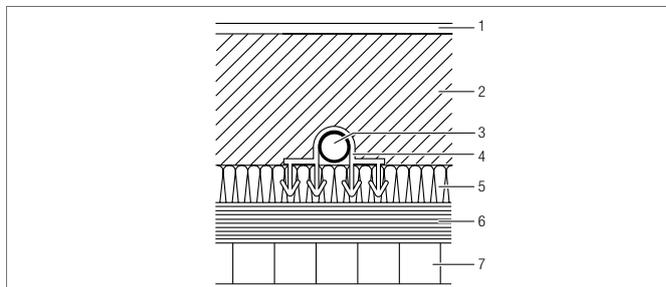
Struttura del pavimento con isolamento aggiuntivo
